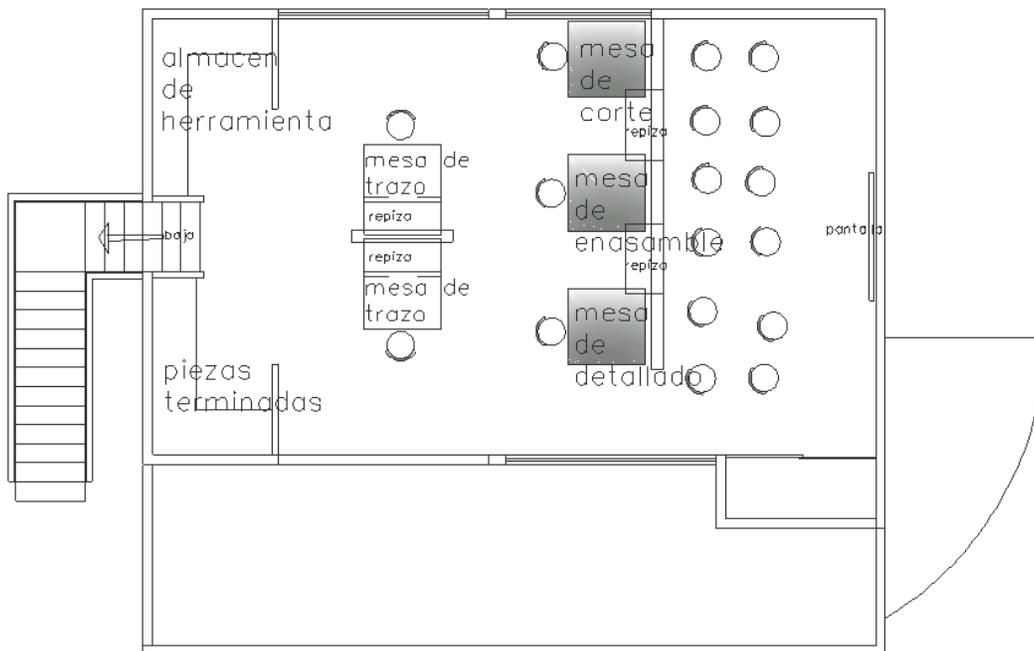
Distribución de la planta alta (taller de maquetas).
